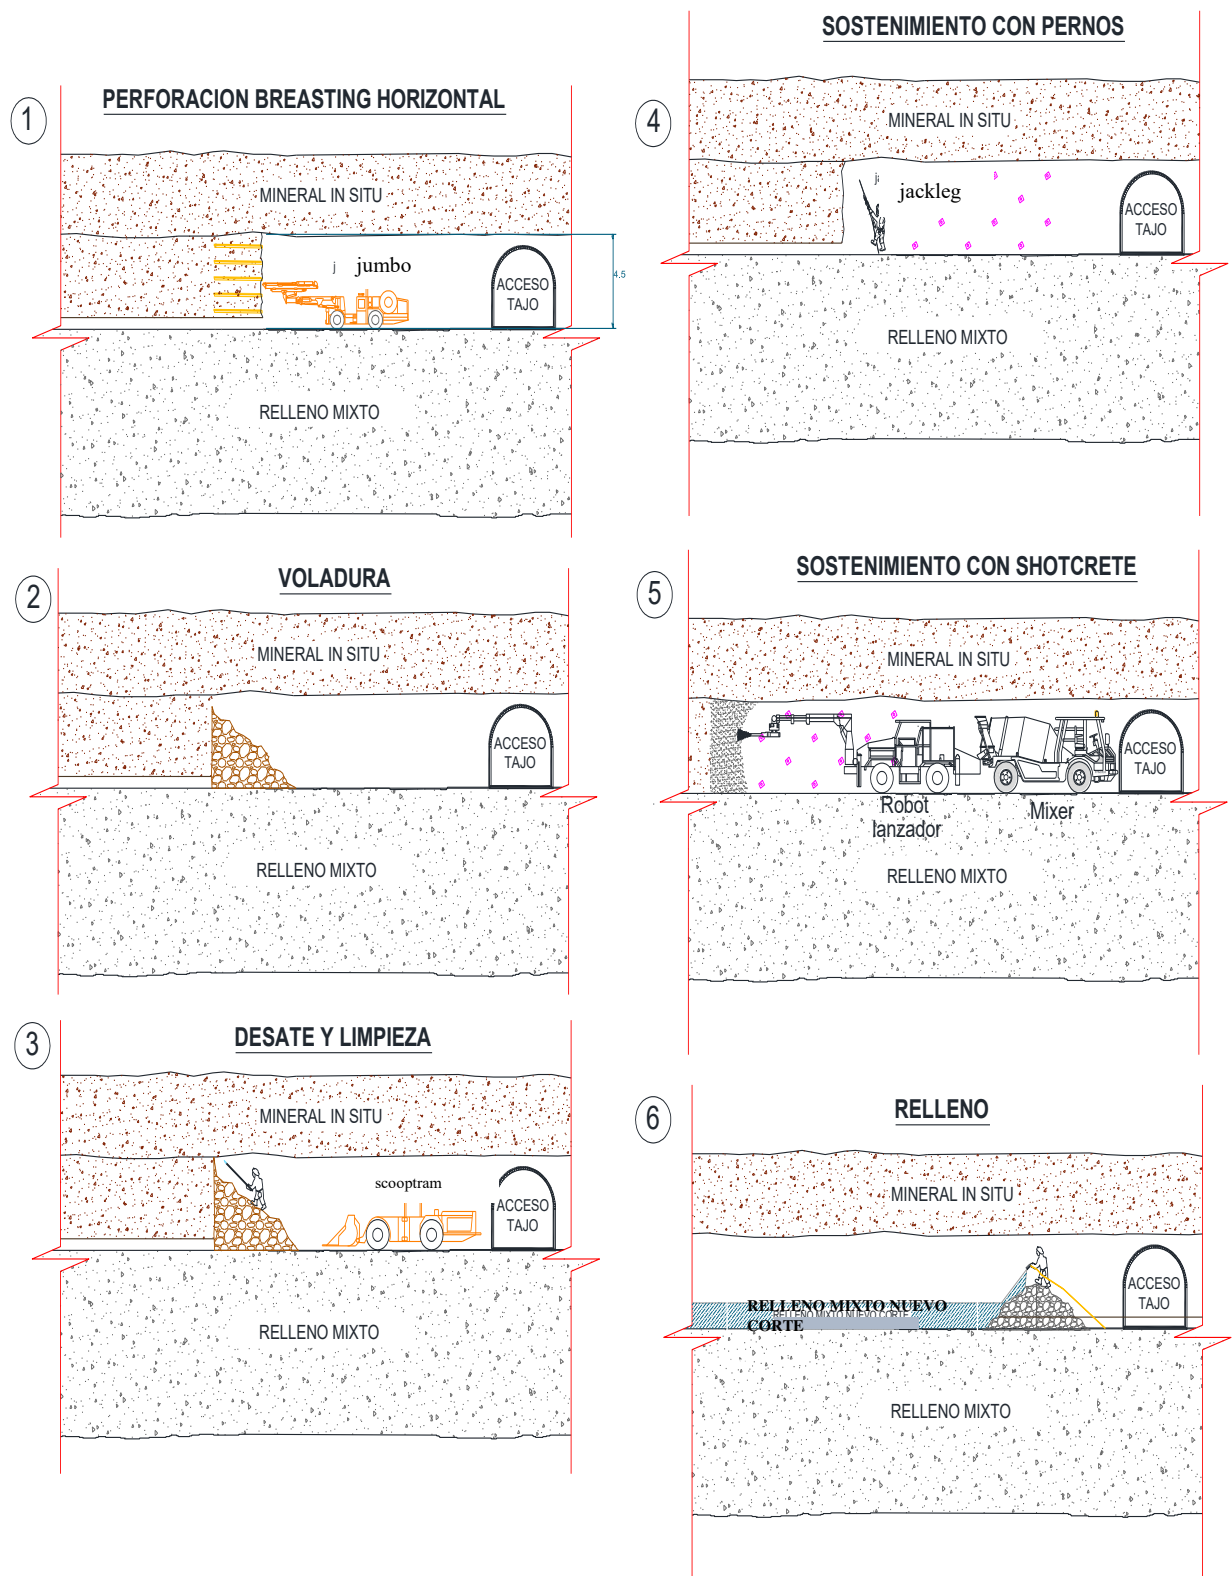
Ciclo de minado mecanizado explotación en breasting horizontal
